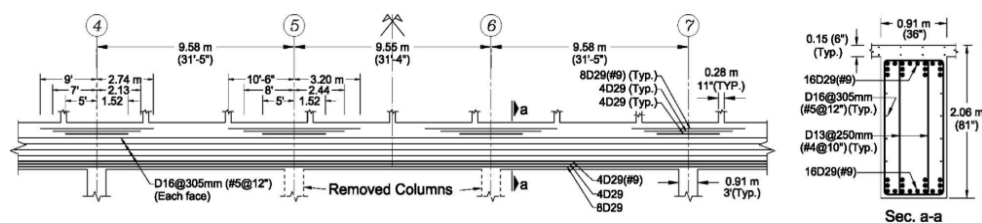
Detalhe das armaduras da viga no eixo B (Sasani et al., 2011)
